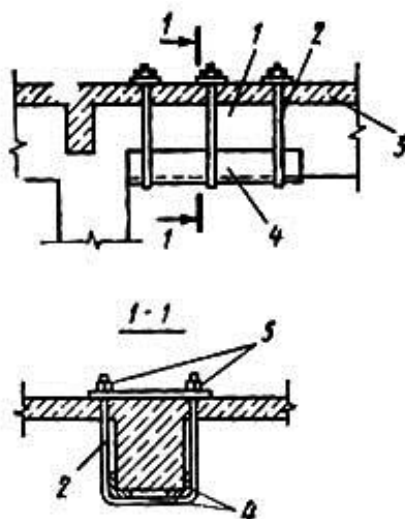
Усиления балок по наклонному сечению хомутами: 1 – усиливаемая балка; 2 – хомуты; 3 – плита перекрытия; 4 – упорные уголки; 5 – гайки
